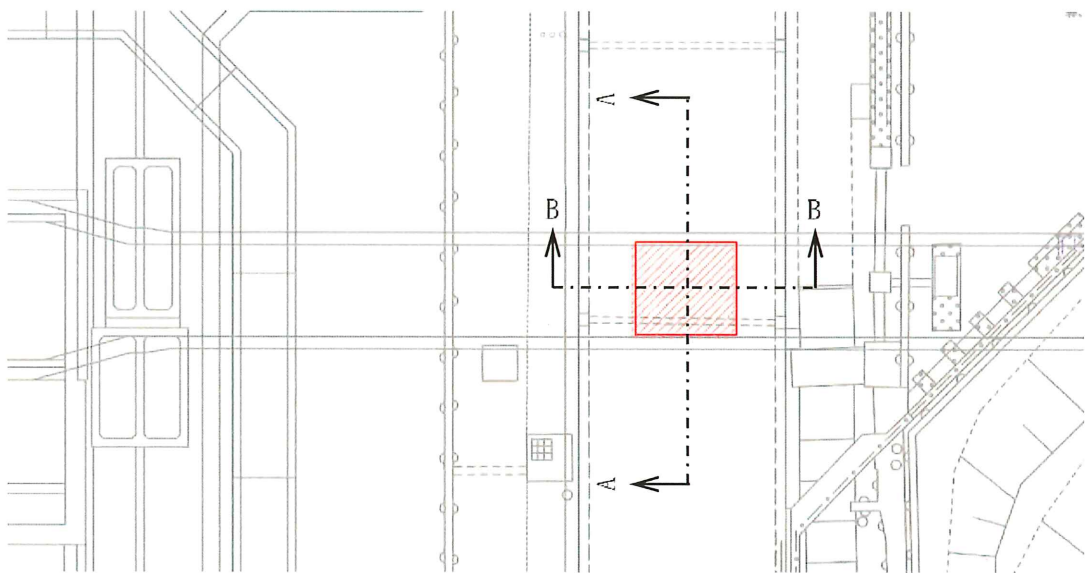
(1) 取放水路流路縮小工（第1号機放水路） 平面図
